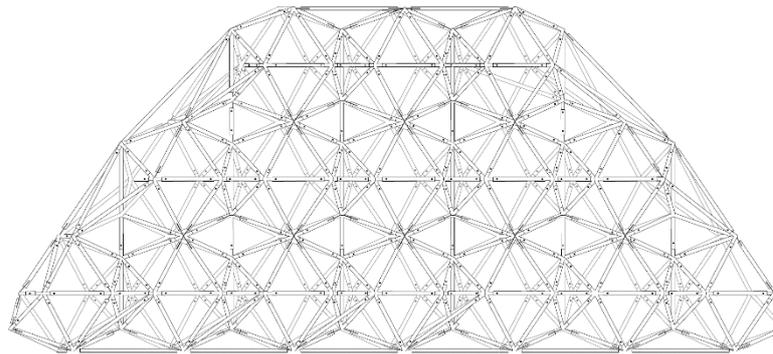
Planta cubierta reticulada. Fuente: Elaborado por estudiantes MySE II 202420
